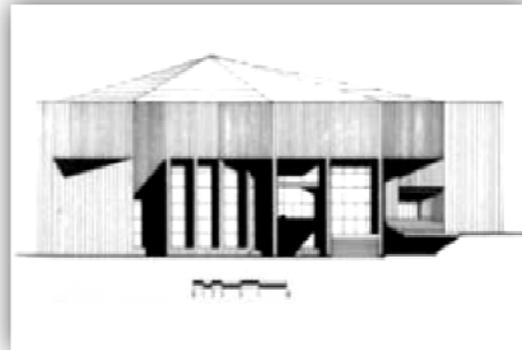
Fachada poniente. Sin escala. Fuente: Concert halls and opera houses. Beranek, L.
